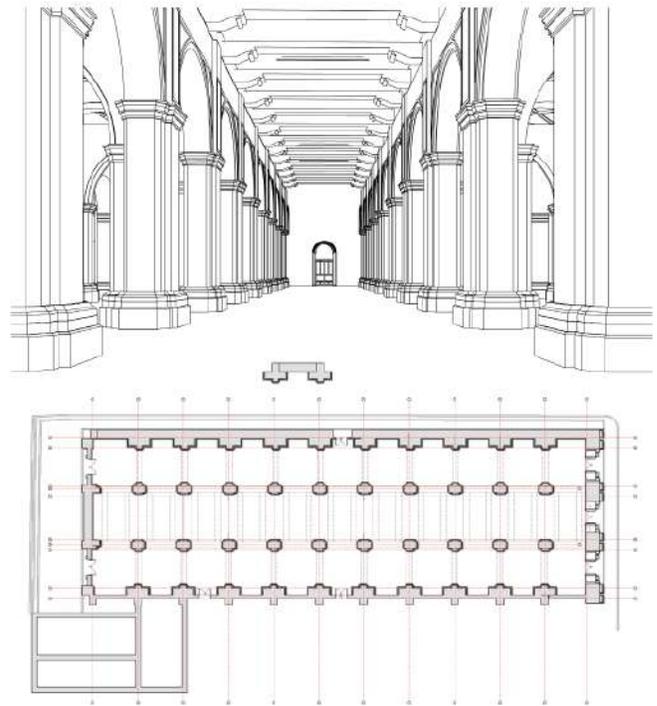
Reconstrucción de planta y espacio interior de la catedral del siglo XVIII.
